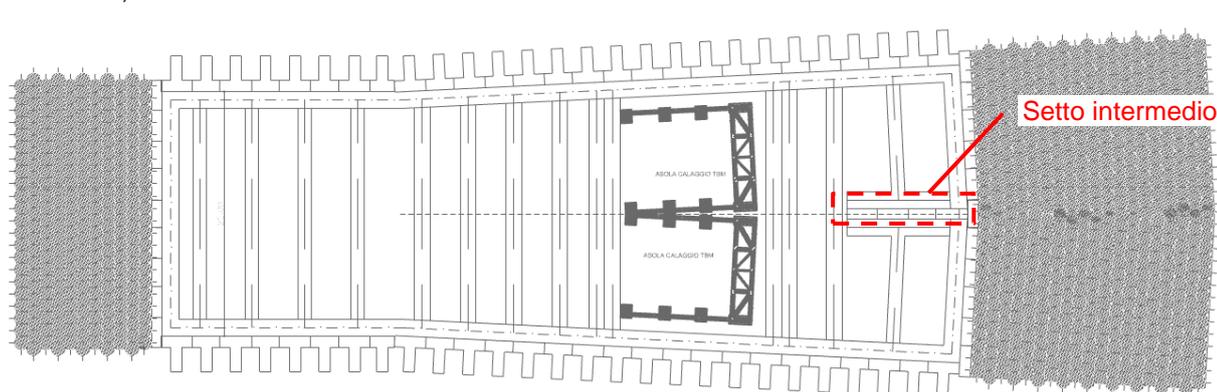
Vista in pianta pozzo : setto intermedio
